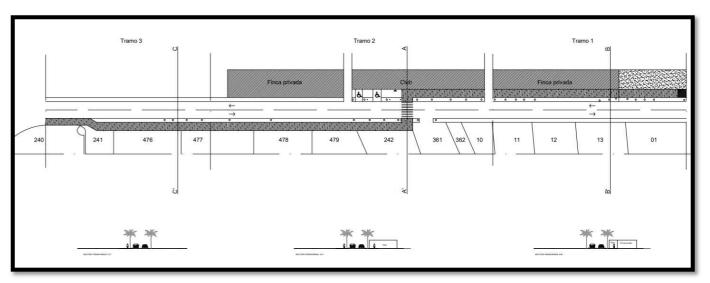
Secciones transversales. Fuente: Elaboración propia
